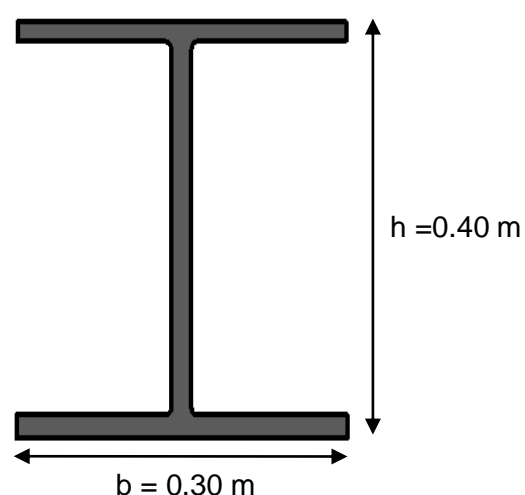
VIGA TIPO HEB 400 (0.40 x 0.30) m
